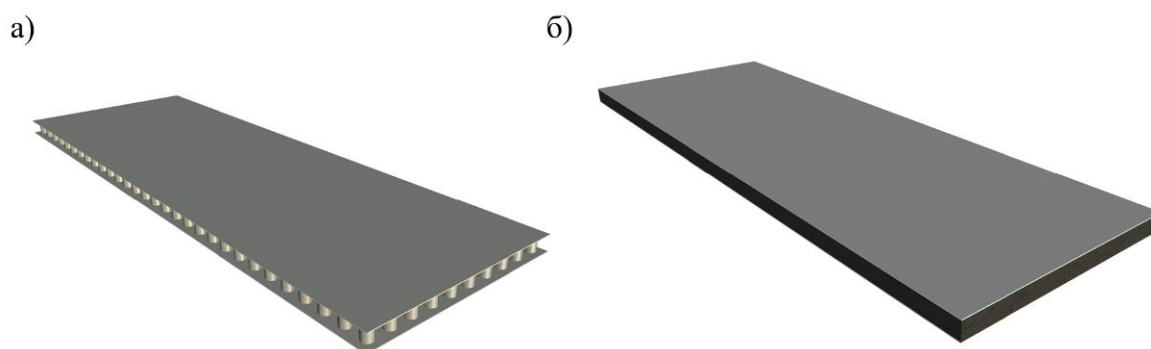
Многослойные стальные плиты перекрытий: а – плиты B-Core компании Broad Sustainable Building, б – многослойные плиты с заполнением пеностеклом.
